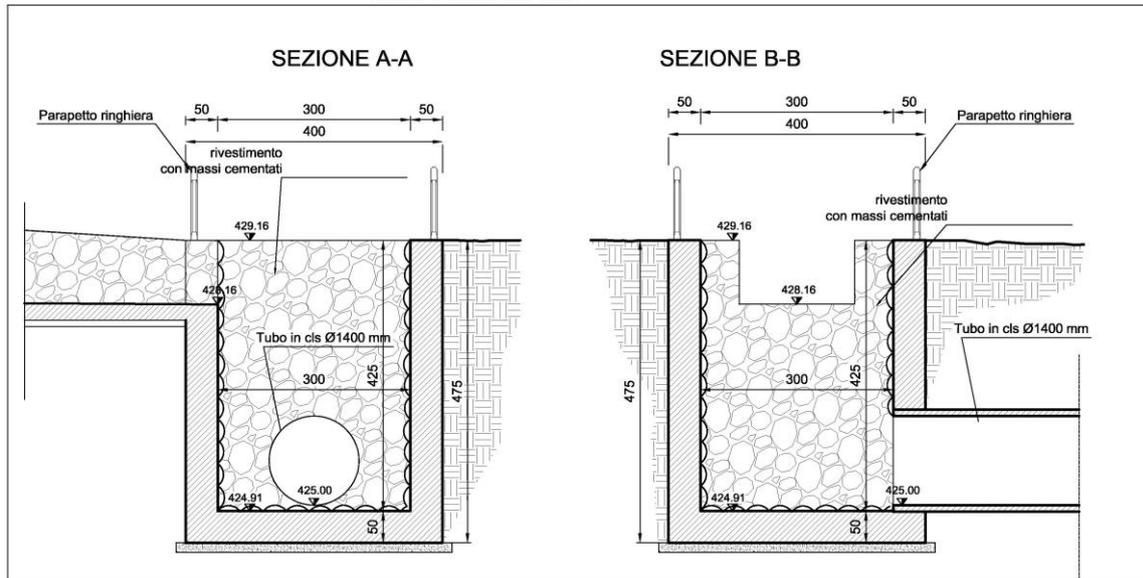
Sistema compluvio sud – Pozzetti VS8-VS11 - Sezione
